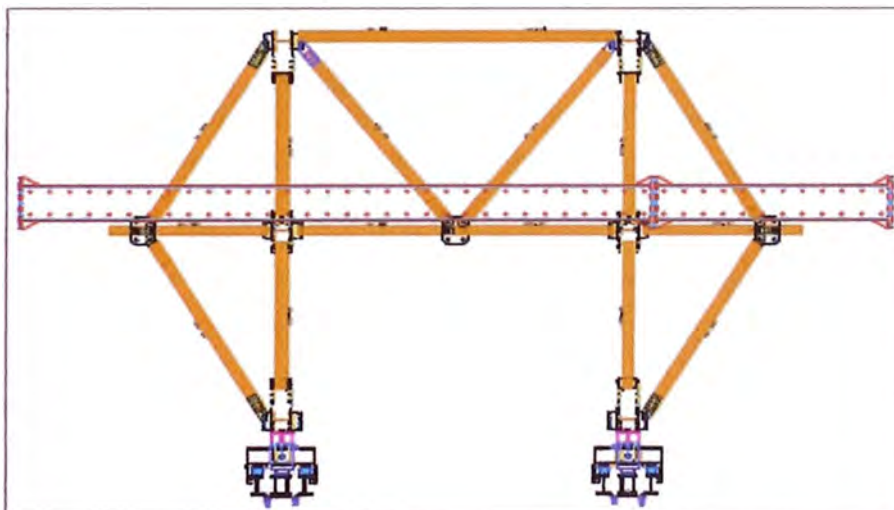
Vista Sección de posición de Perfil U-500.
